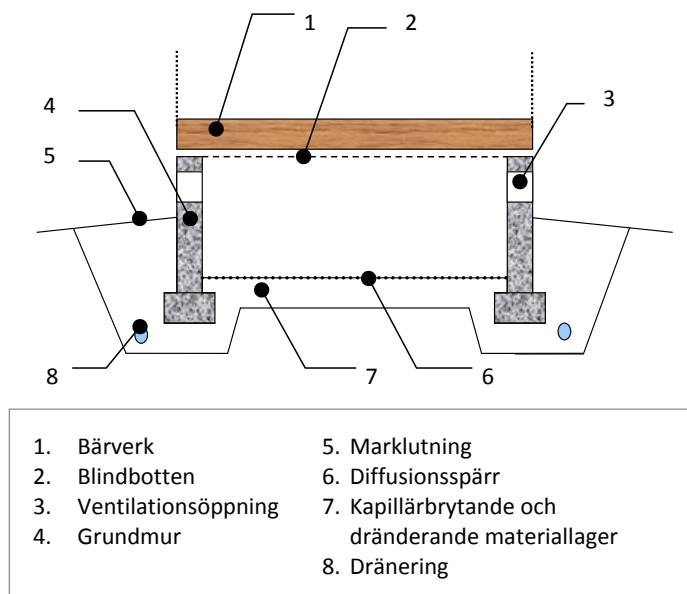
Uppbyggnad av en uteluftsventilerad krypgrundskonstruktion.
